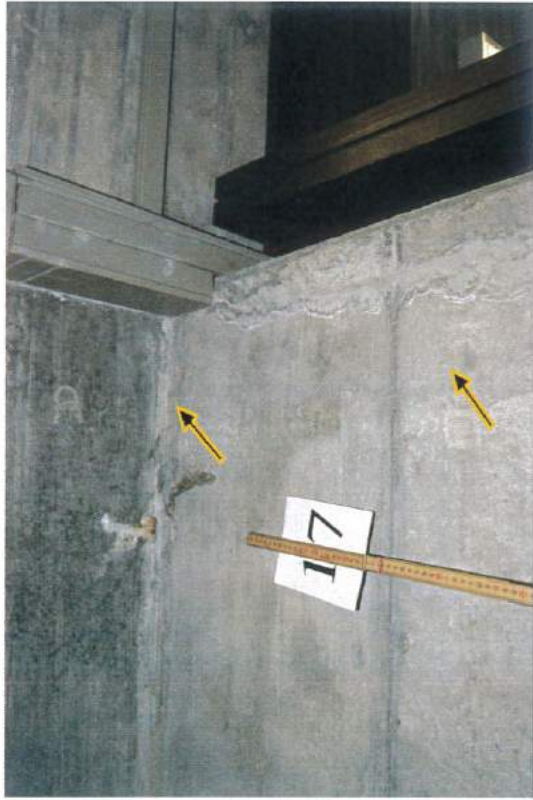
UBICAZIONE: soffitto gradinate zona accesso da terrazzo esterno 1°p.
